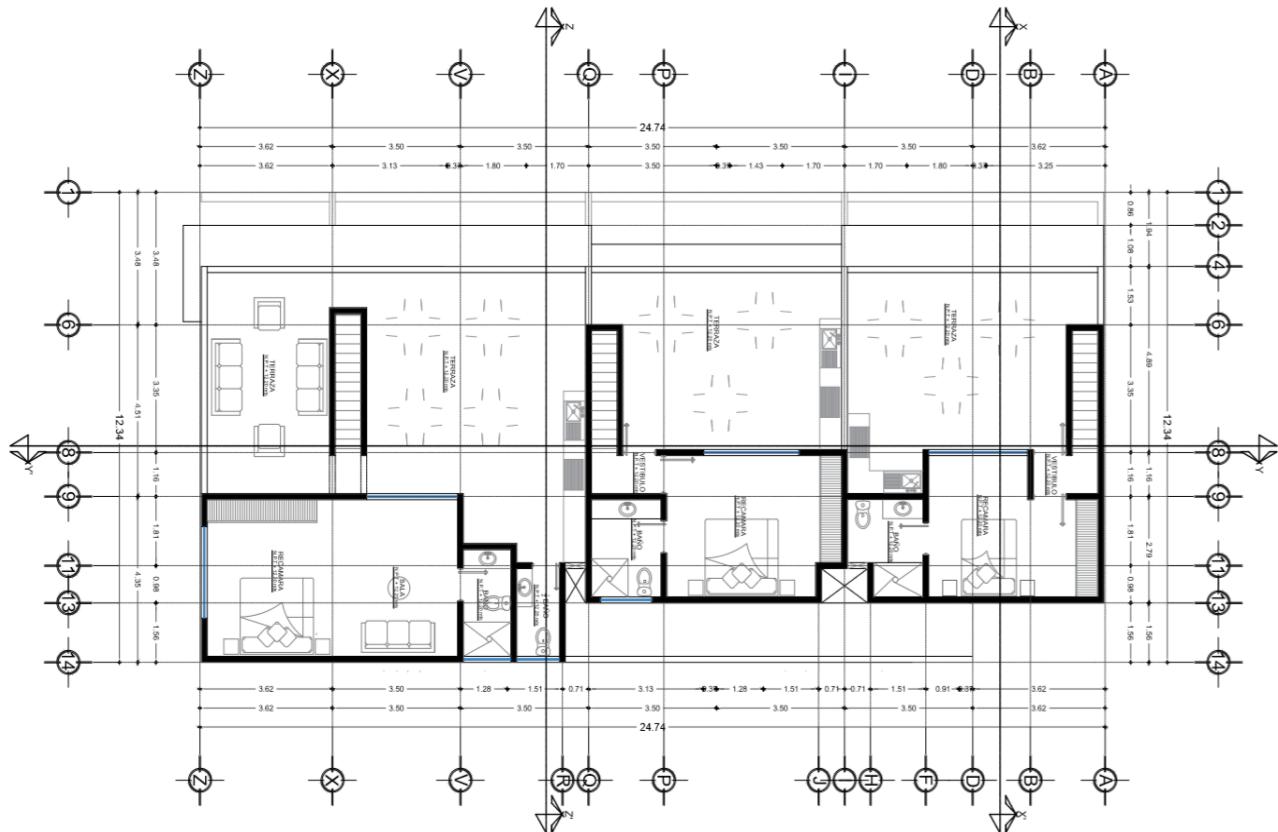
Planta arquitectónica de la azotea del Edificio A.
